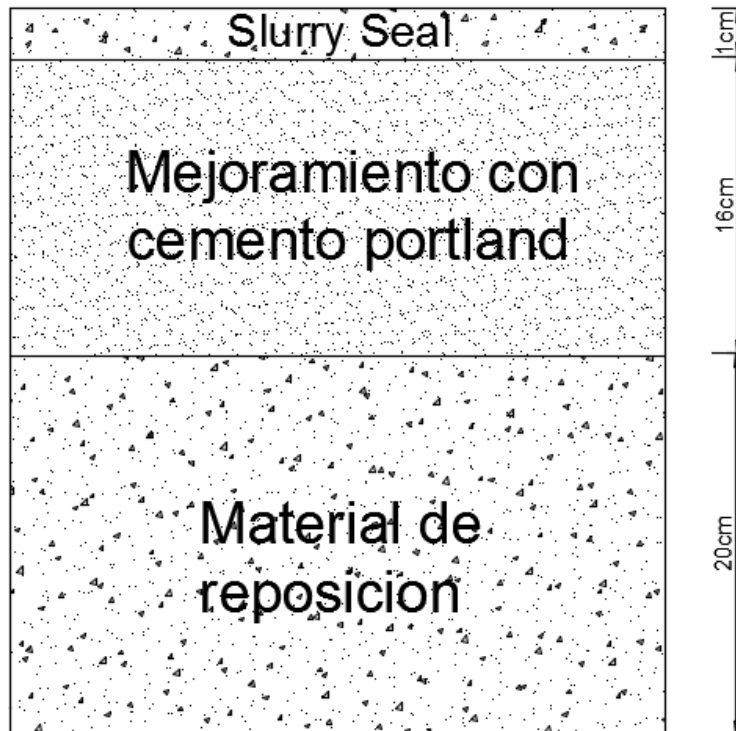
Sección de pavimento de carretera Bellavista – Ledoy. (Fuente: Elaboración propia)
